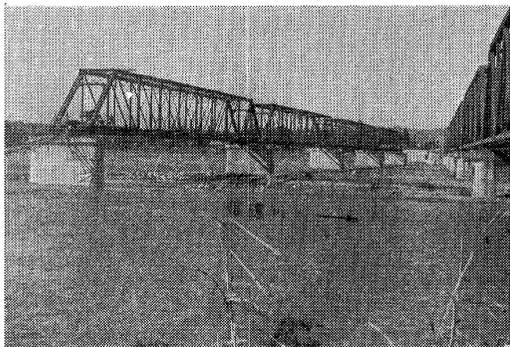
下流側へ拡幅量の 1/2(1.265 m) だけ横移動
